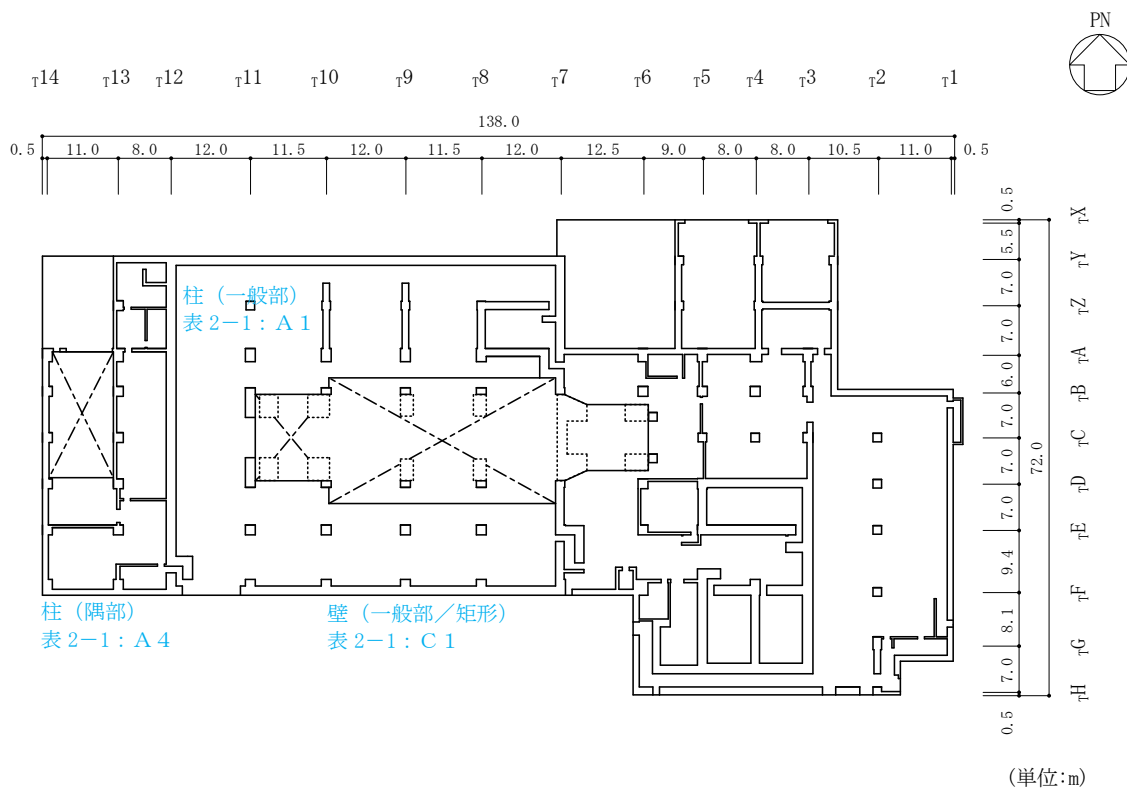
(3) タービン建物の概略平面図 (EL 12.5m)
